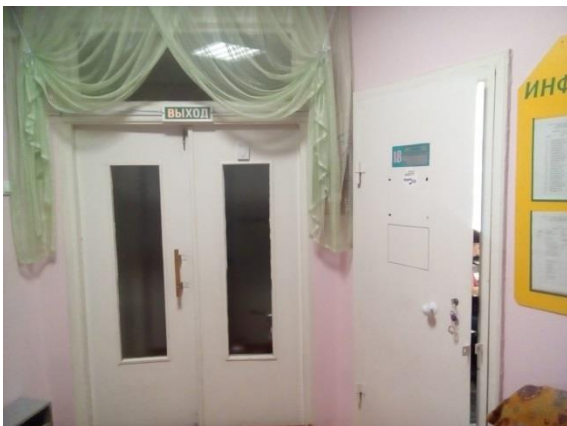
Выход из здания 1 этаж (путь эвакуации)
